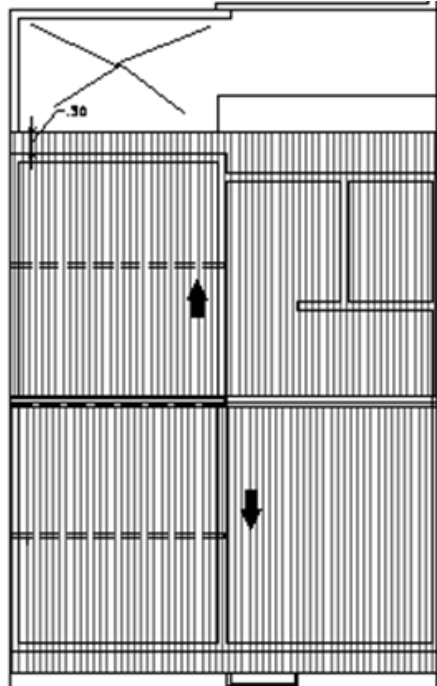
Corte de vivienda apareada. Valle del Ortigal
